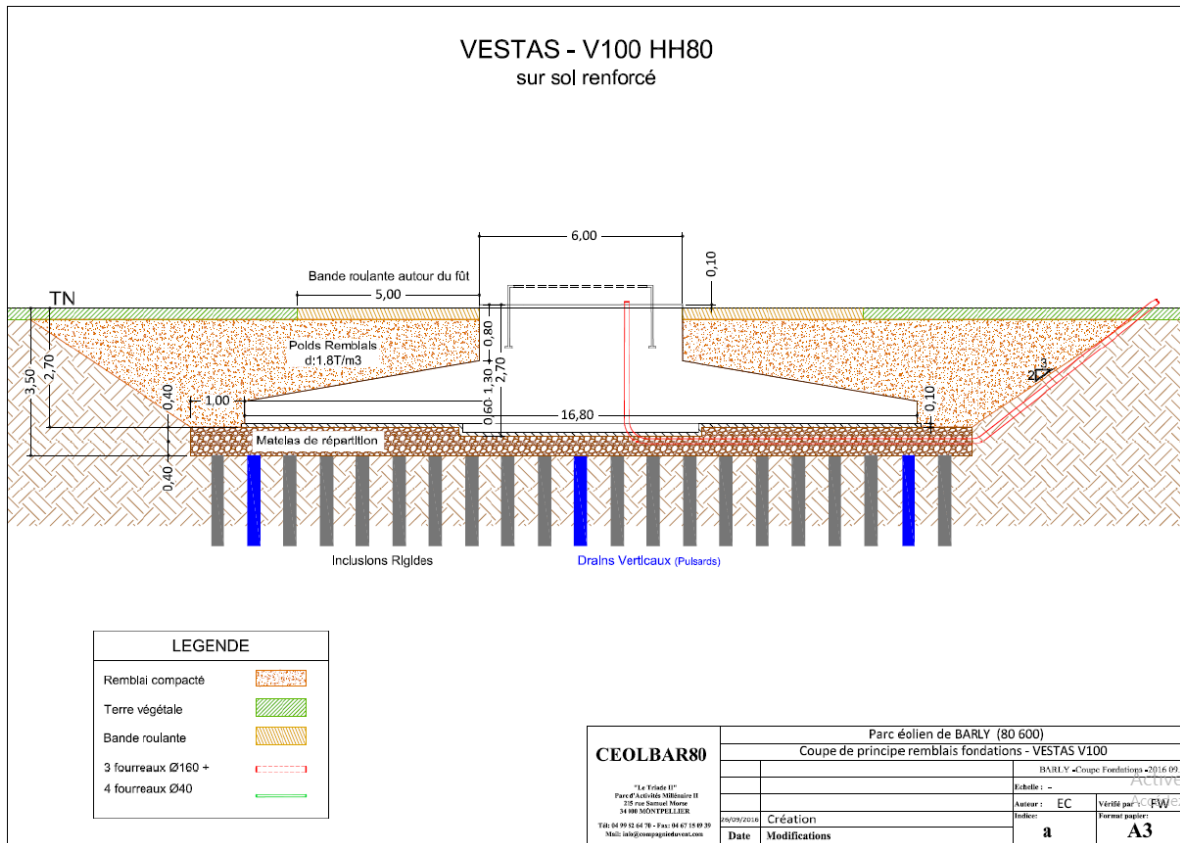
Schéma d'une fondation avec sol renforcé (Source : LCV, 2017)
